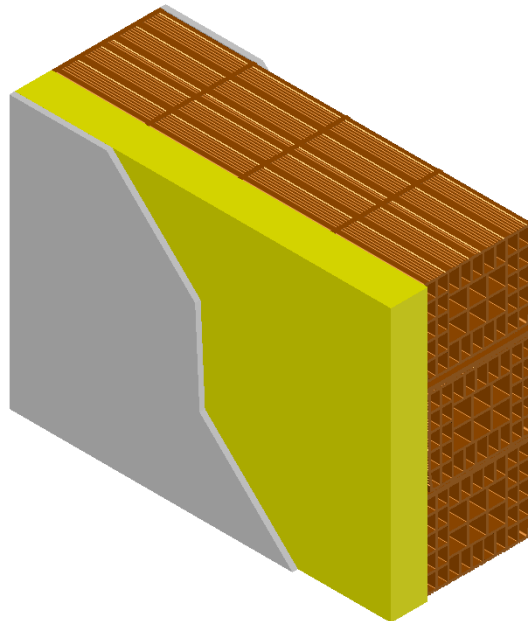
Spaccato assonometrico di muratura “Recente” – Parete B
